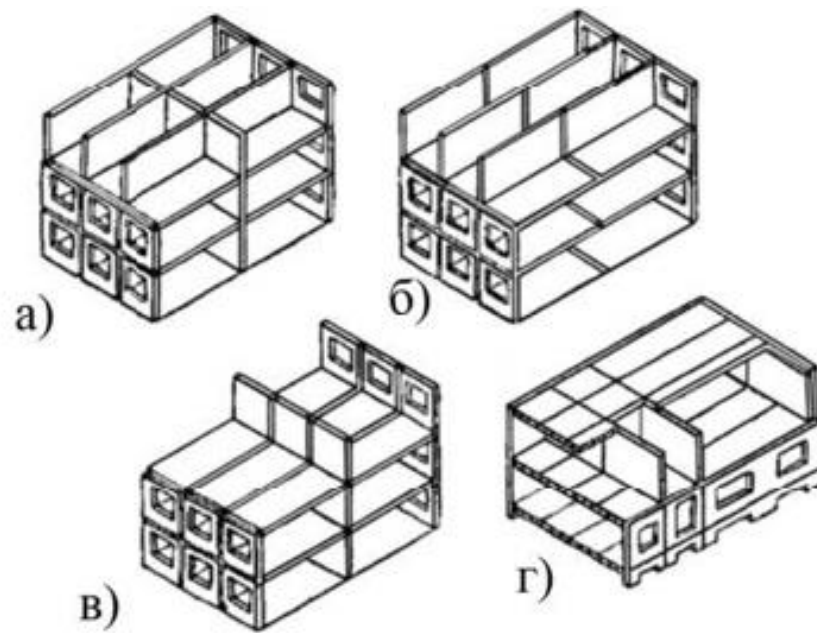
Конструктивні схеми безкаркасних великопанельних будівель: а) із зовнішніми несучими стінами і поперечними і поздовжніми несучими перегородками; б) зовнішніми несучими стінами і поперечними несучими перегородками; в) зовнішніми і внутрішніми поздовжніми несучими стінами; г) з поперечними несучими стінами
